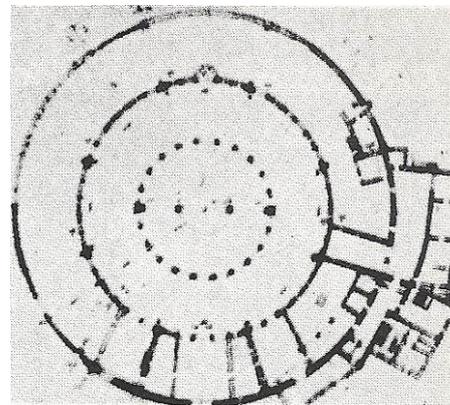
Planta depois da restauração (funcional) da Igreja S. Stefano Rotondo.
